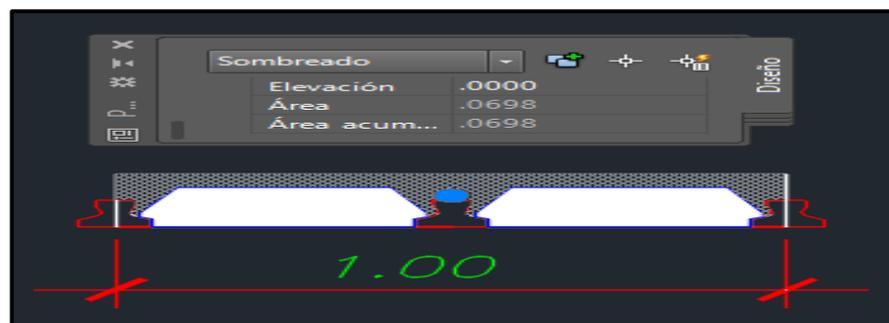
Detalle de consumo de concreto de una losa de 20cm con bovedilla de poliestireno.
